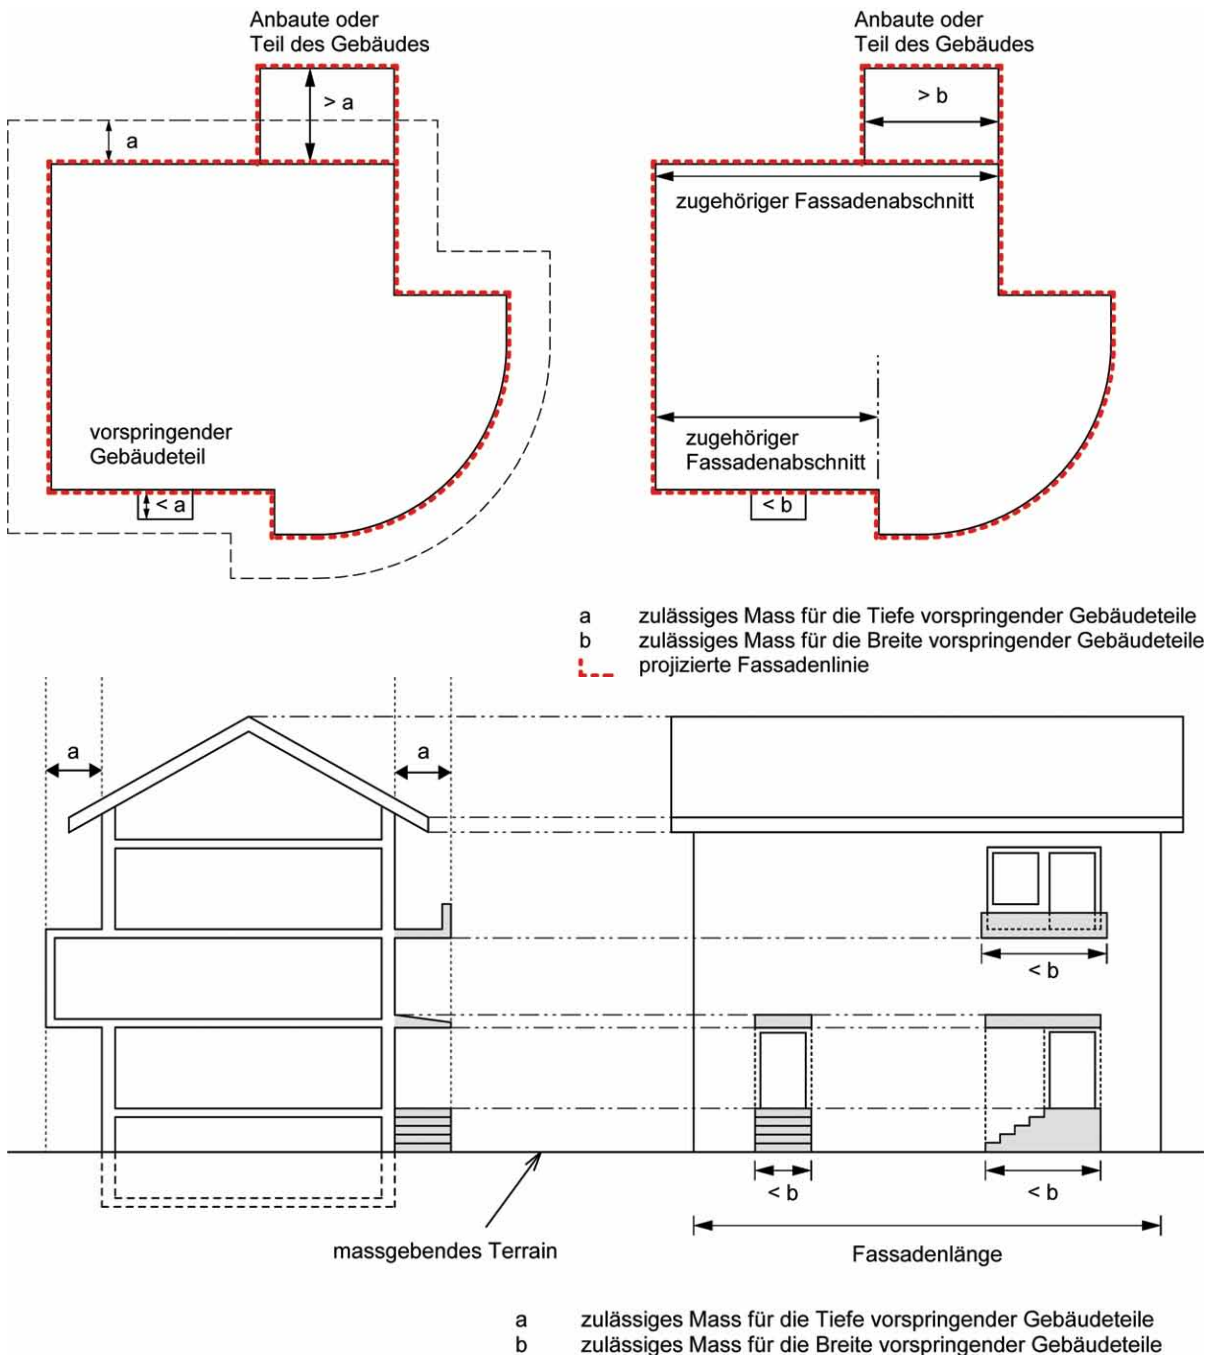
3.3 Fassadenflucht und Fassadenlinie
